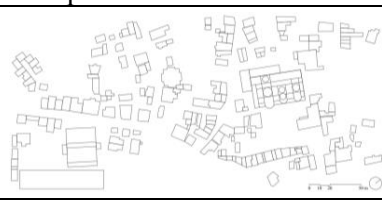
SSK Kompleksi ile Zeyrek Mahallesi, birlikte gösteren bütünleşik blok planı
